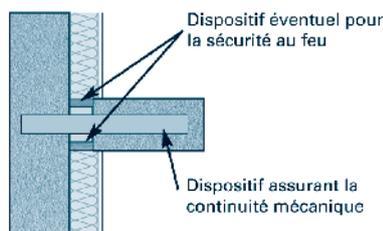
Schéma de principe d'un rupteur pour dalle béton
